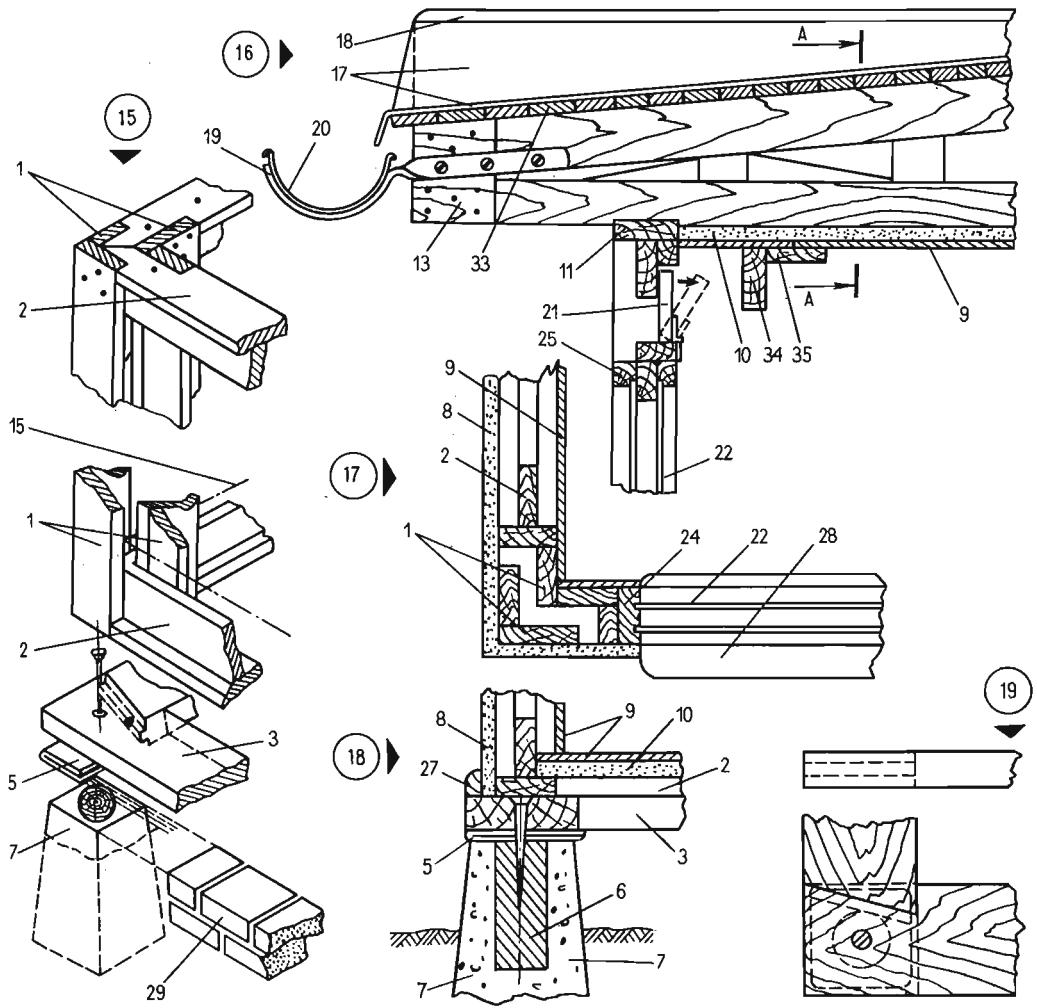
Горизонтальный разрез угла здания — соединение панелей и окна угловым столбом
